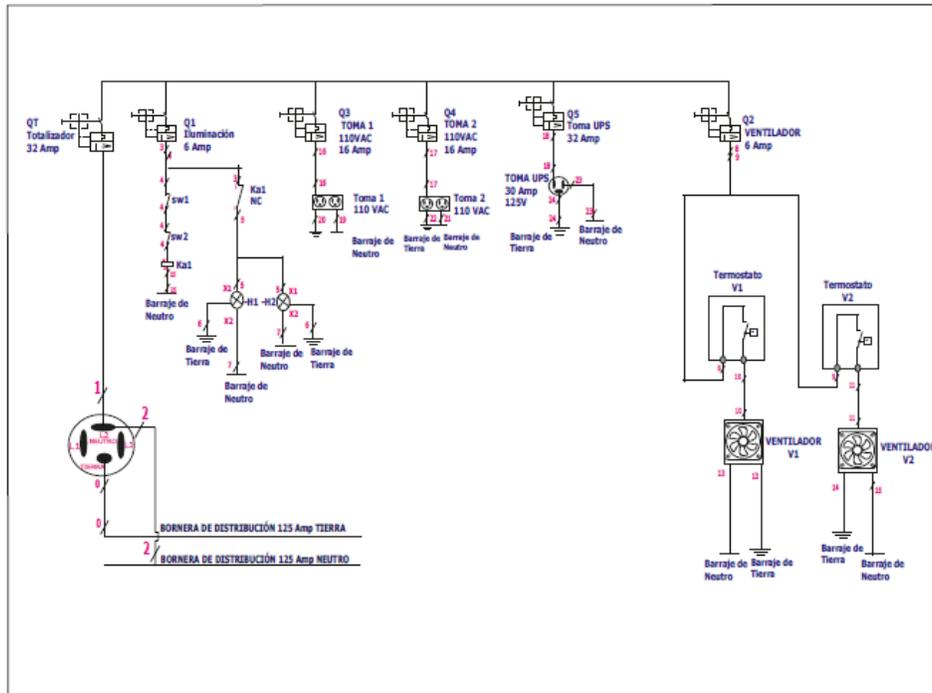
Plano eléctrico de la cabina tipo shelter.
